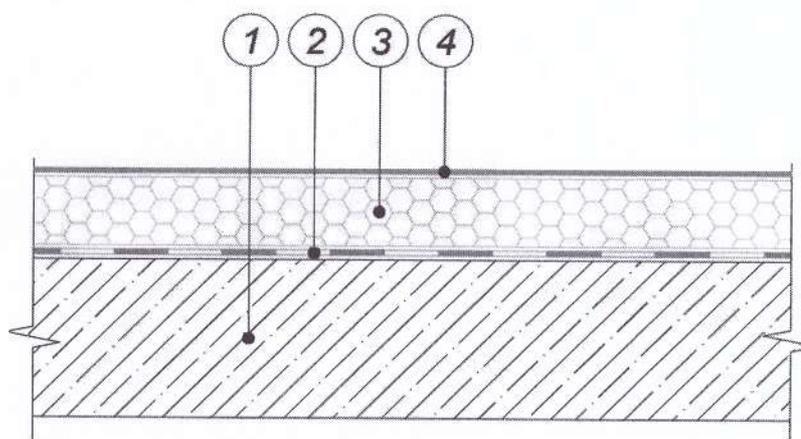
Схема конструктивного исполнения железобетонного чердачного перекрытия с системой утепления ТН-Чердак PIR (вариант 23)
